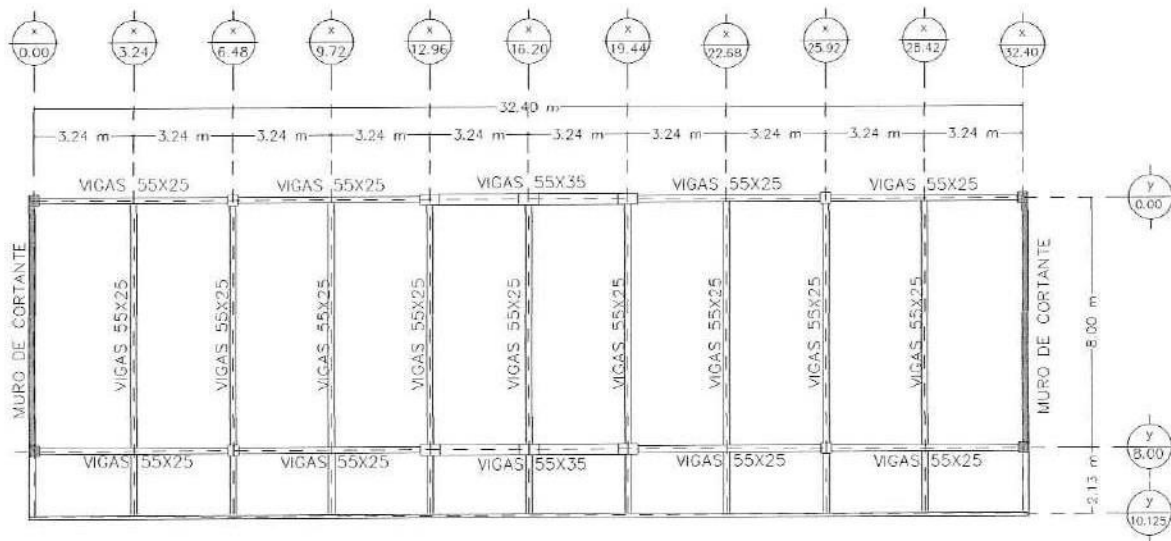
Edificio tipo para aulas en la UABC (Vista en Planta).
